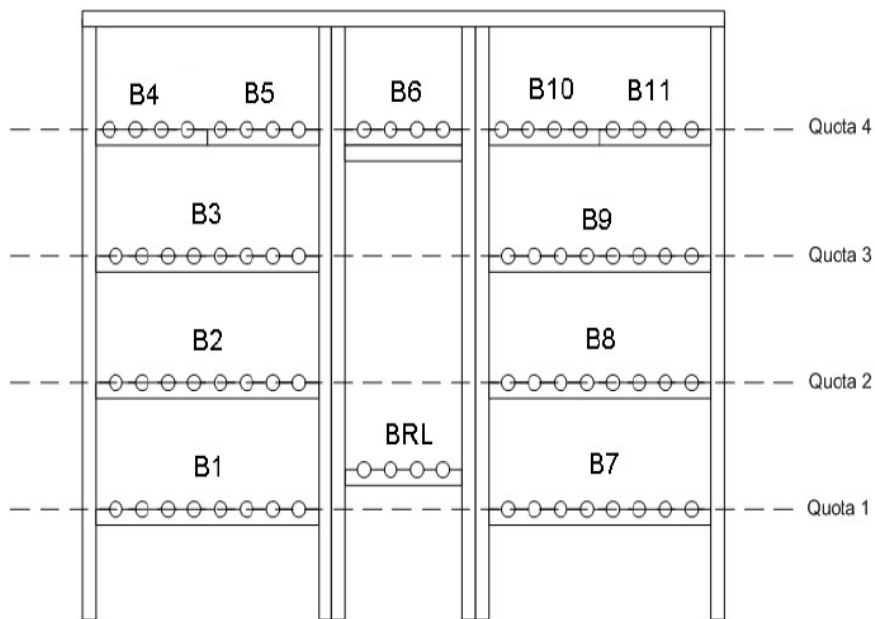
Prospetto Zona B del magazzino automatico presente in laboratorio.
